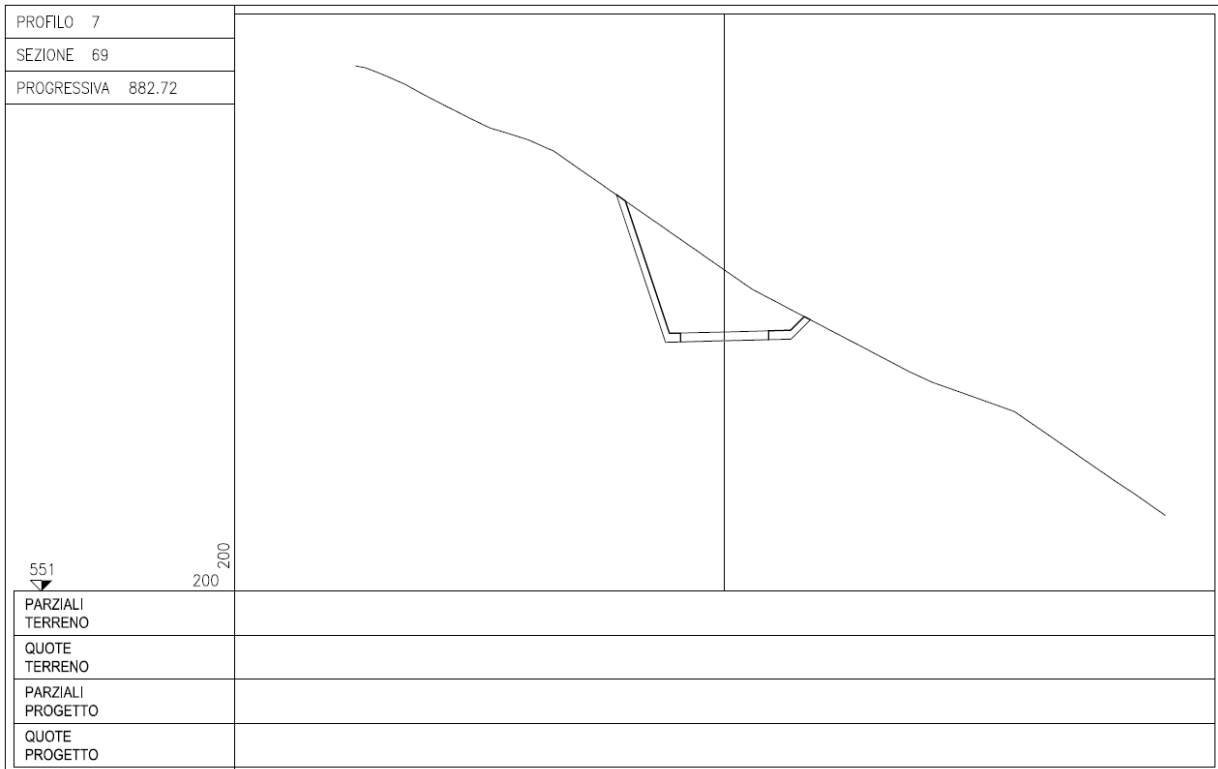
Sezione di calcolo n. 69 alla pk 0+882.72
